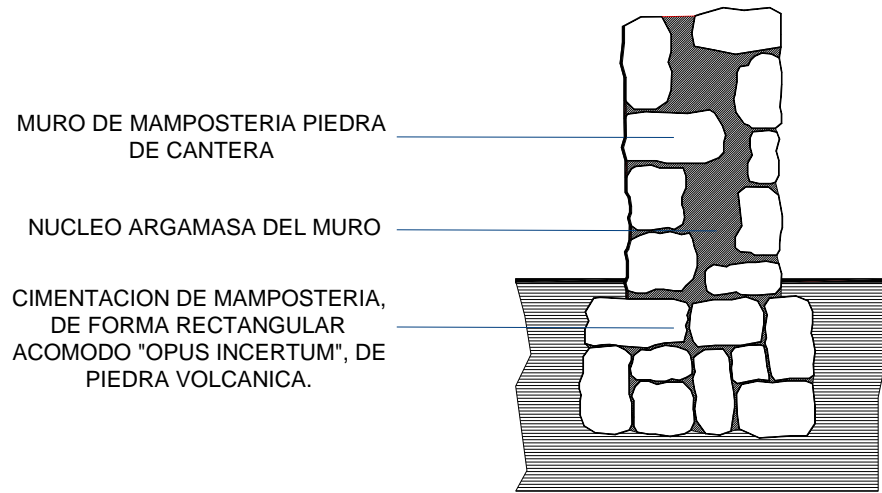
Detalle de la cimentación de mampostería rectangular.
